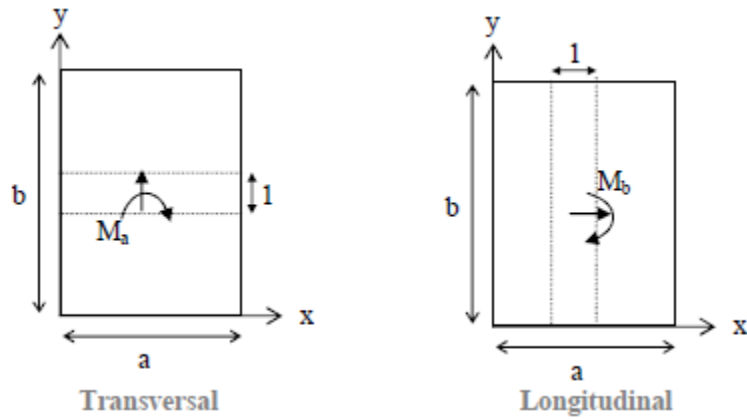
Moment transversale et longitudinale sur la dalle centrale
